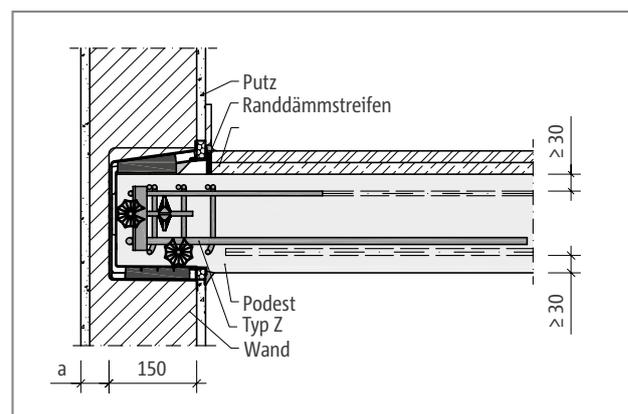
Schöck Tronsole® Typ Z: Brandschutzausführung
